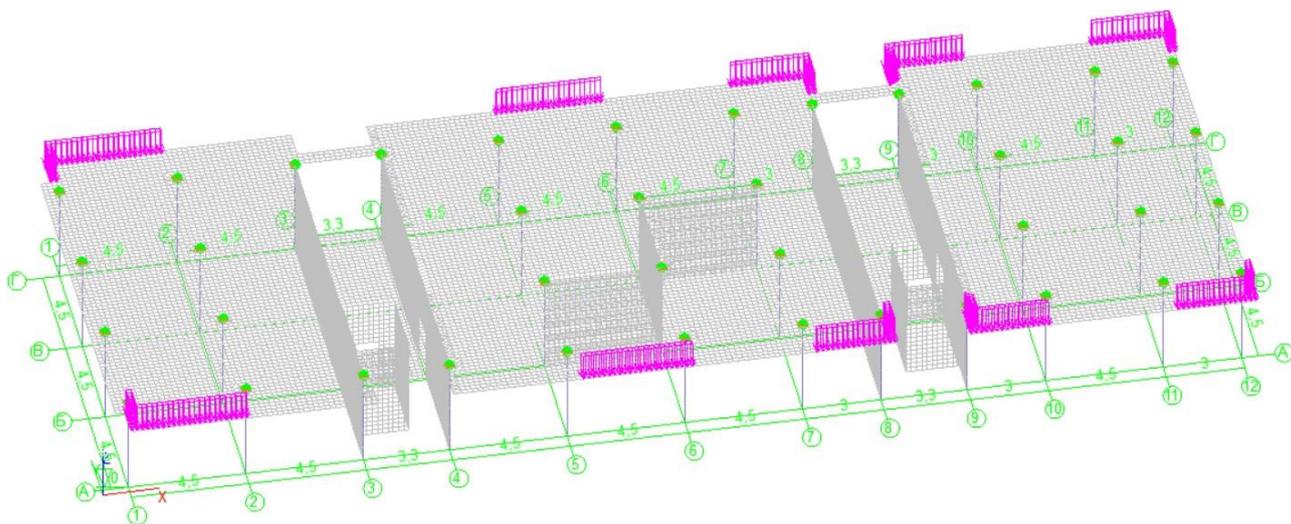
Общий вид постоянного нагружения перекрытия от собственного веса балконных ограждений
